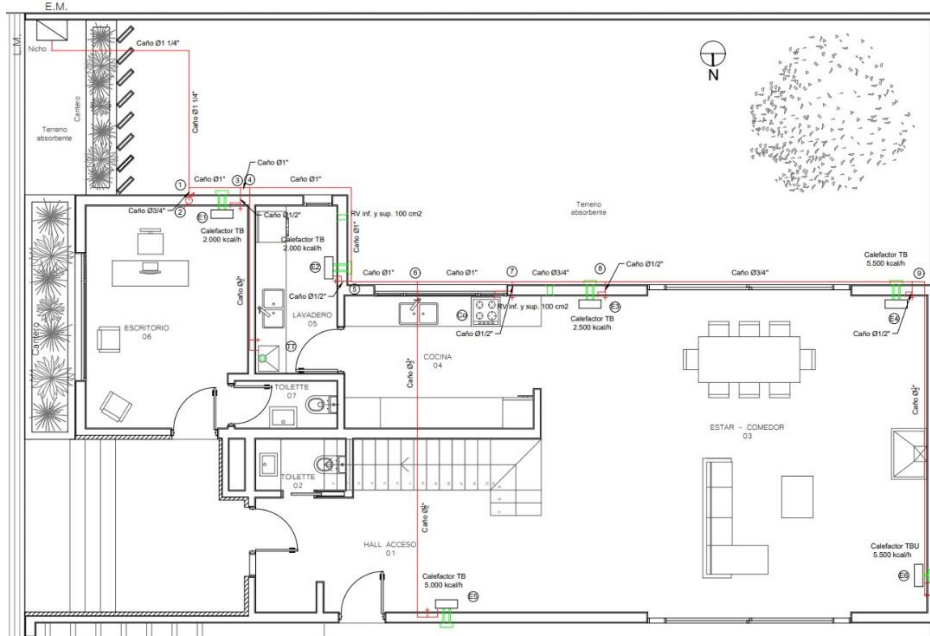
Trazo de cañerías de gas y ubicación de artefactos en planta baja
